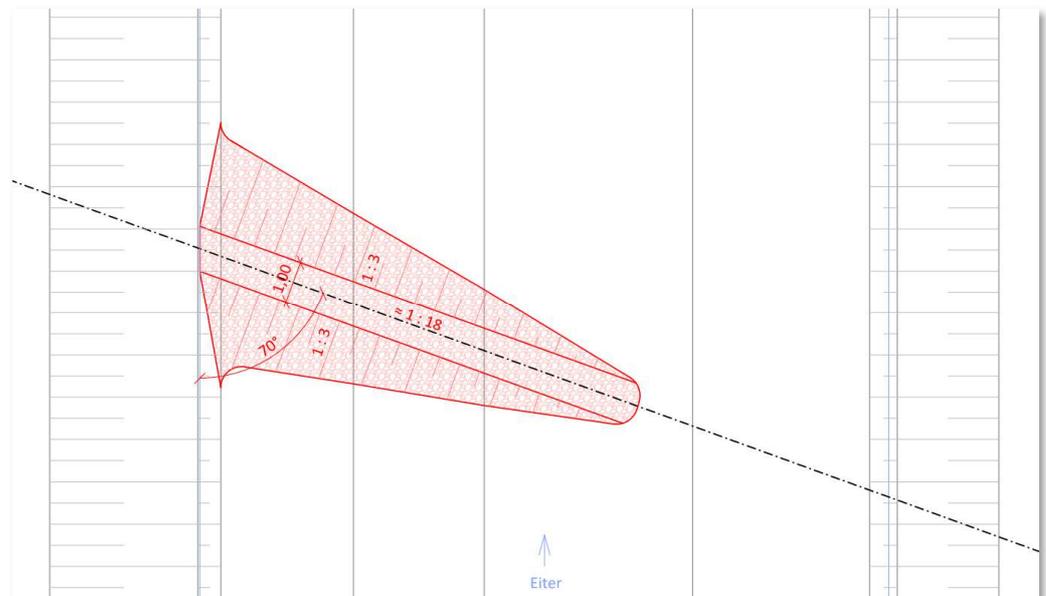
Draufsicht einer Buhne (Auszug Regelzeichnung, o. M.)
